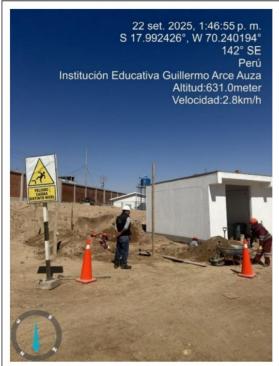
Excavación de zanjas para cimentación en obras exteriores
